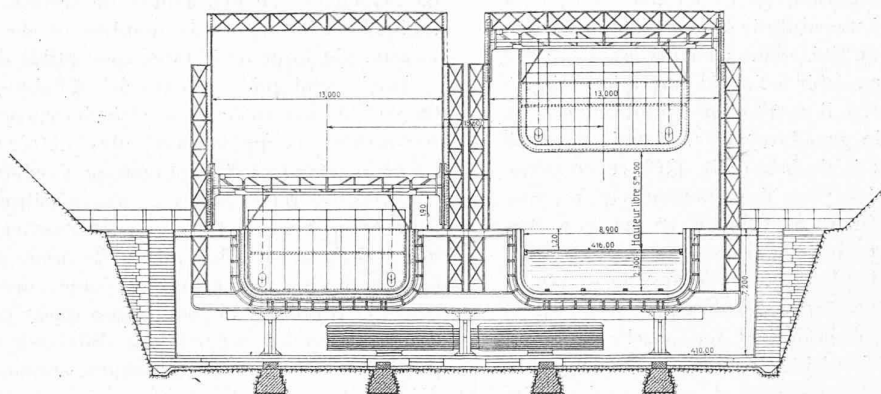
Plans inclinés : installation supérieure. — Vue de face. — 1 : 400.
